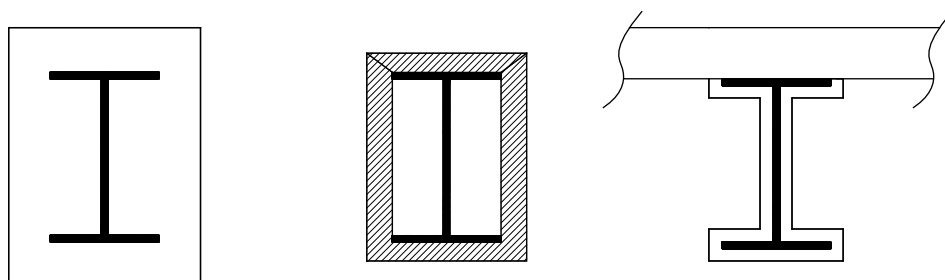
Protezione contro l'incendio per travi e pilastri
